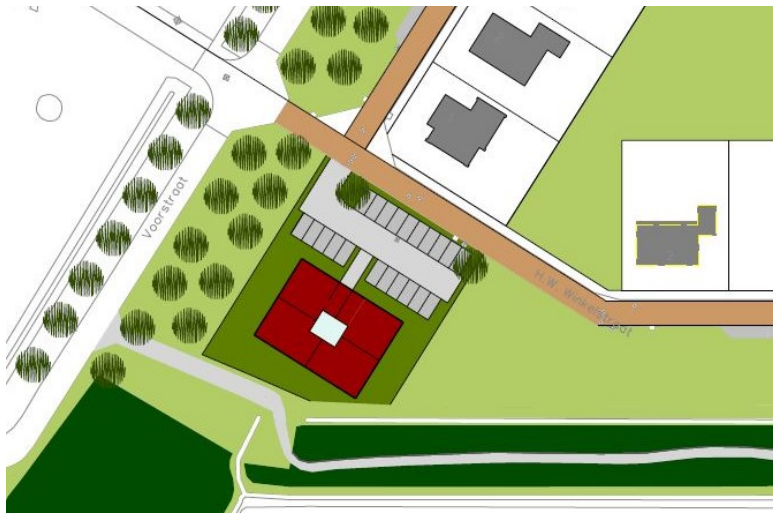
Stedenbouwkundige uitwerking Kraggenburg fase 2
